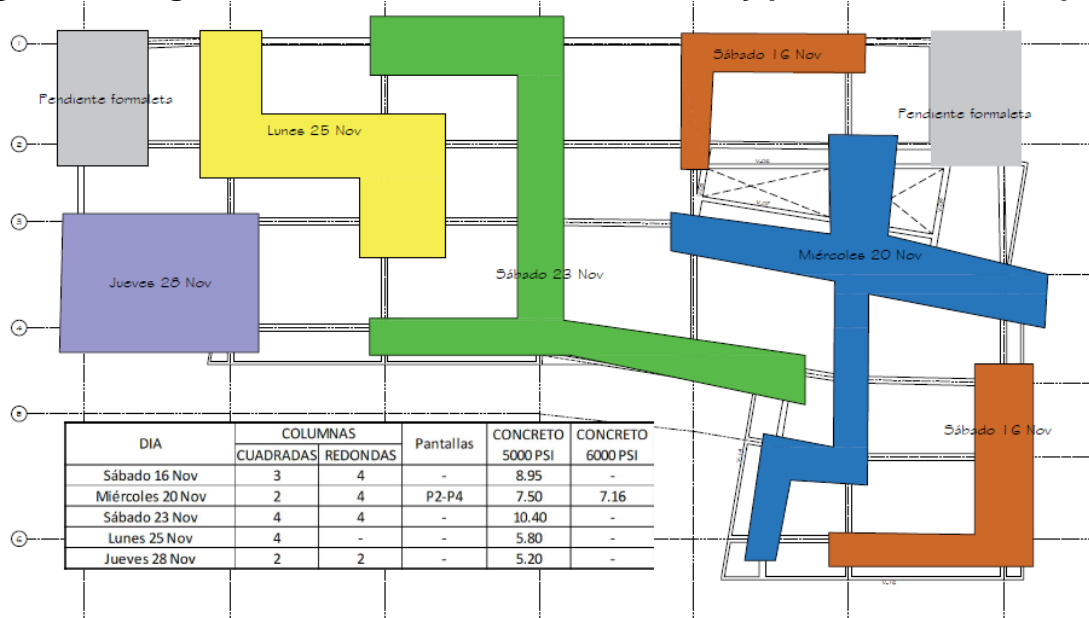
Armado, encofrado y fundición de columnas de tercer piso
